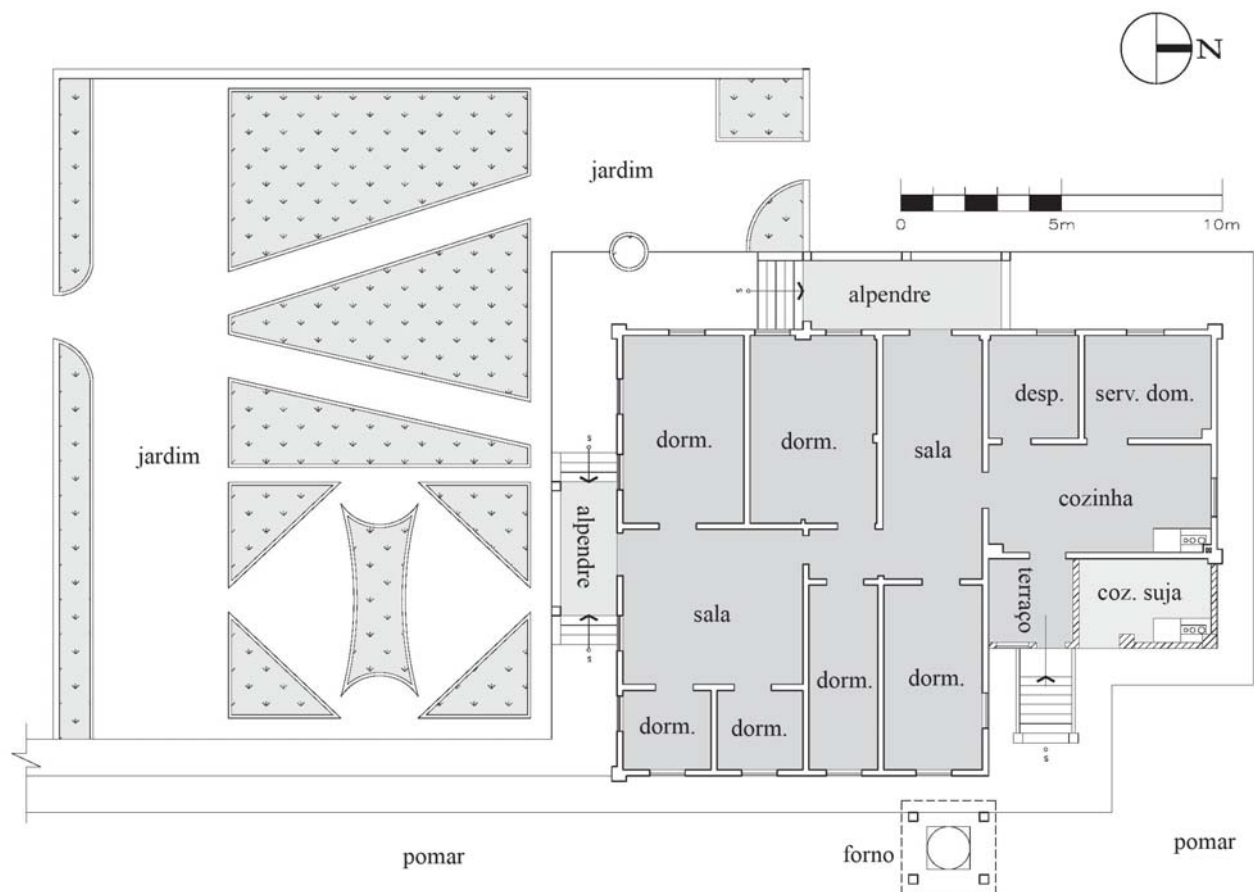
Planta do casarão da fazenda da Bandeira, Descalvado. Lev.: V. Benincasa e M. Rosada. Desenho: V. Benincasa.
